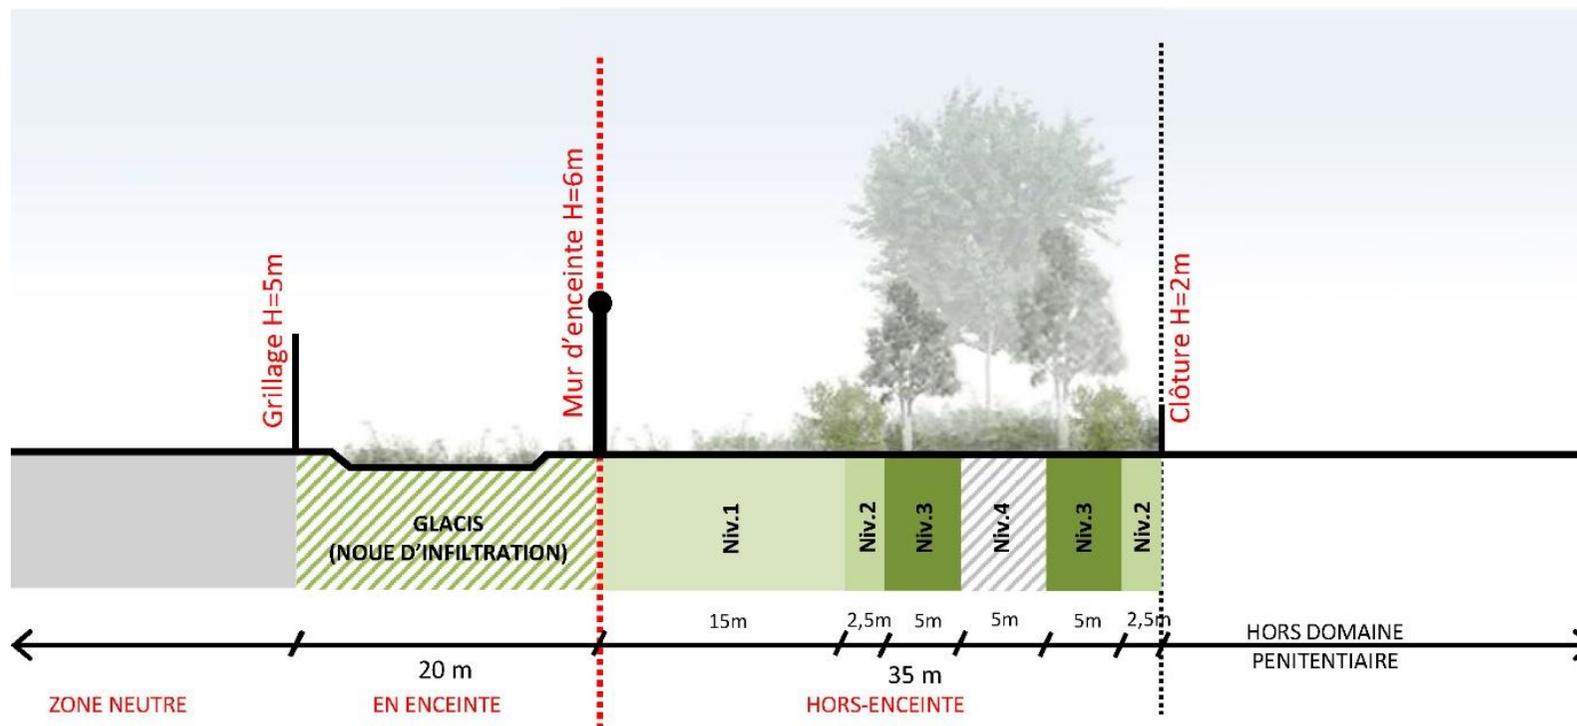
Principe de plantation écran végétal (Source : CCAU paysage, Kelemen)
